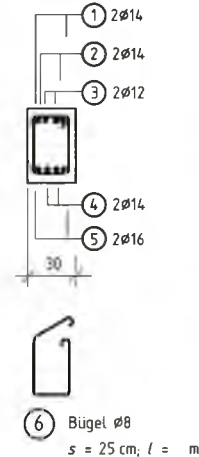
/1: Bewehrungsplan (Stahlbetonsturz als Überzug)
